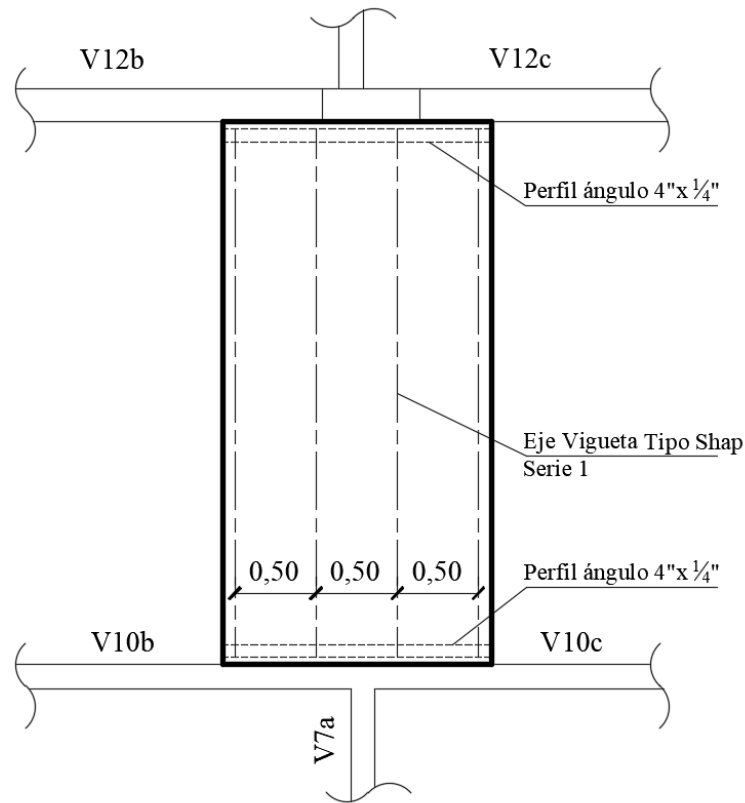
Esquema en planta del sistema SHAP T50 Serie 1, disposición a.
